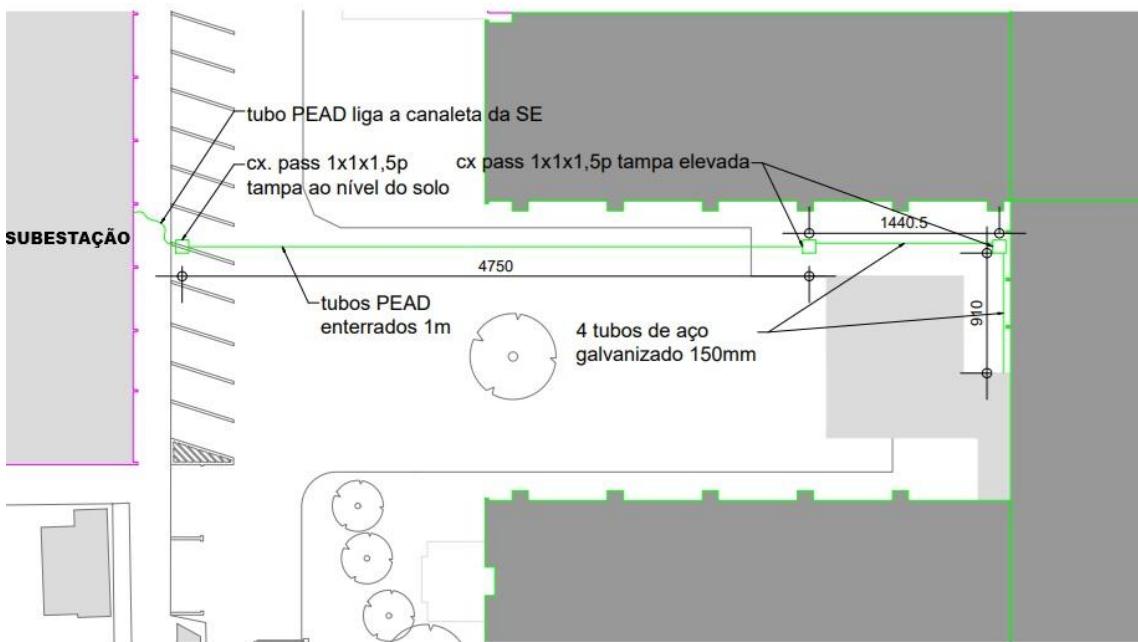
trajeto da conexão QGBT-SE - Painel de Transição.
